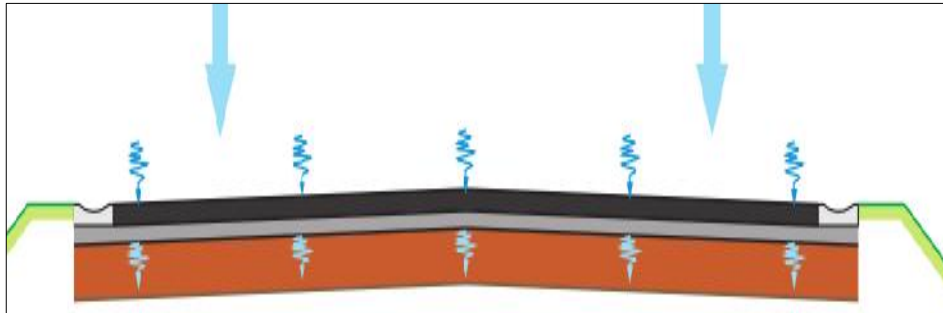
infiltration d'eau par les joints et ou fissures du revêtement
